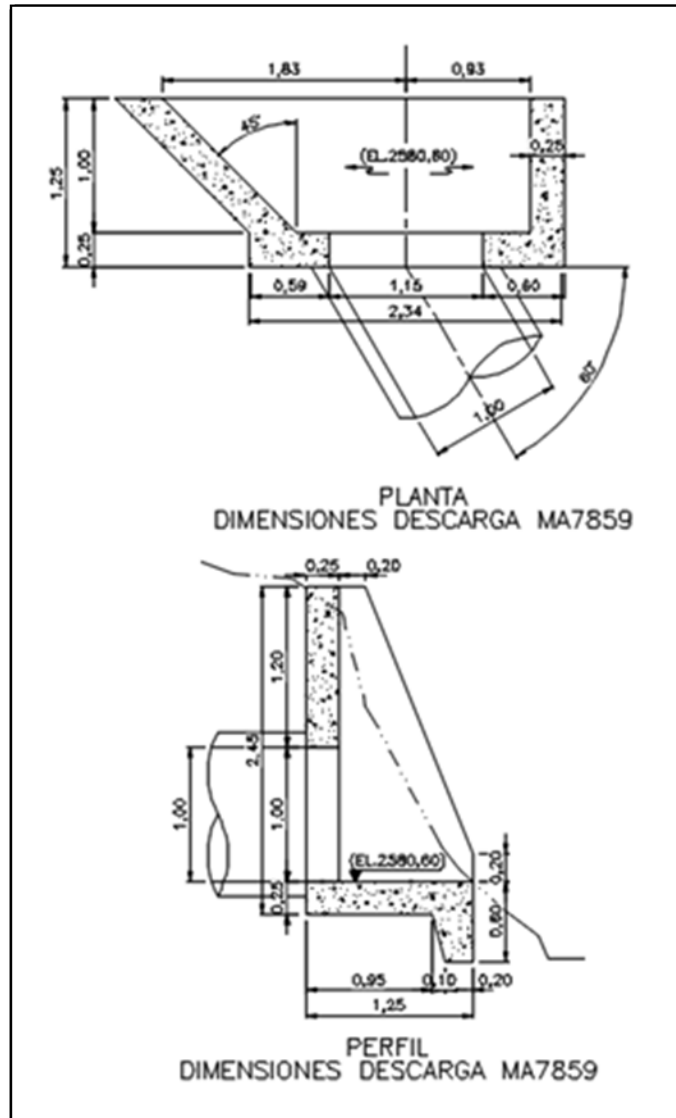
Sección Estructura de descarga OBRA MS7859
